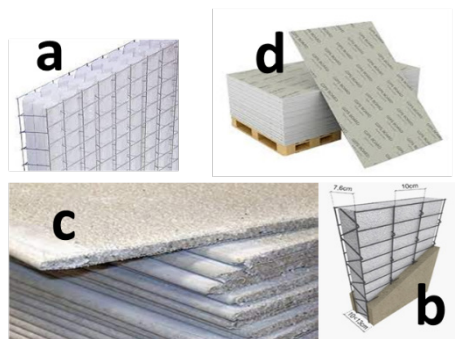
Diversos materiales de construcción para muros de interiores empleados en México bajo normas de construcción.
